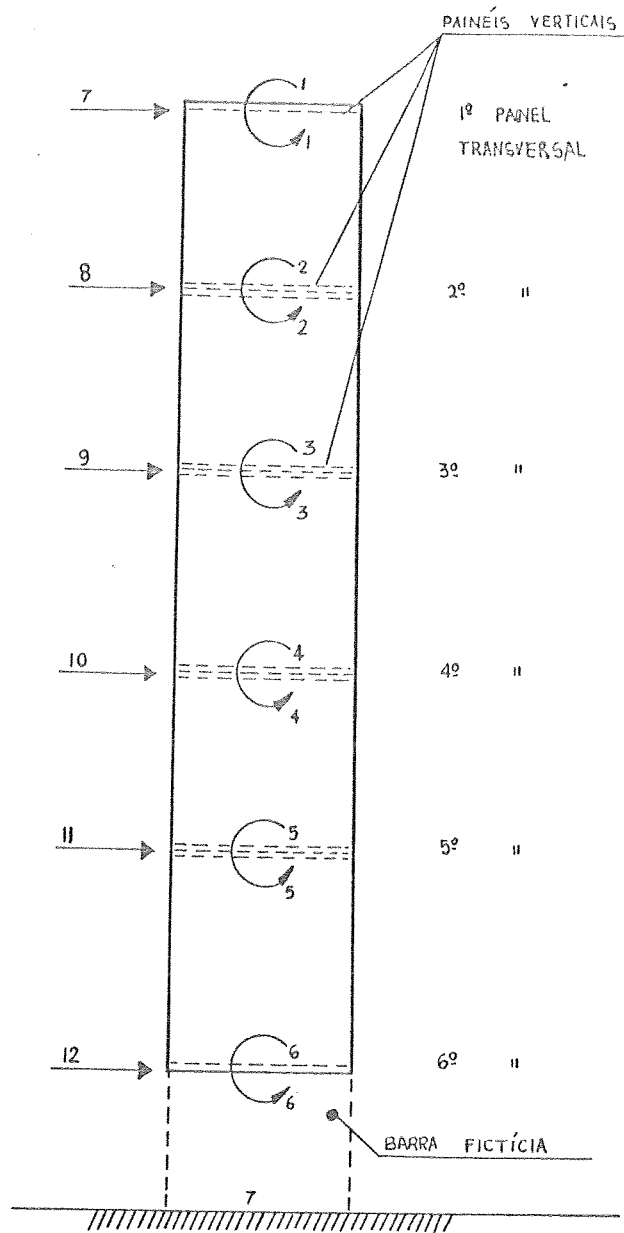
Numeração dos nós e dos deslocamentos da laje. Constitui um "pórtico" com apenas uma prumada de pilares.
